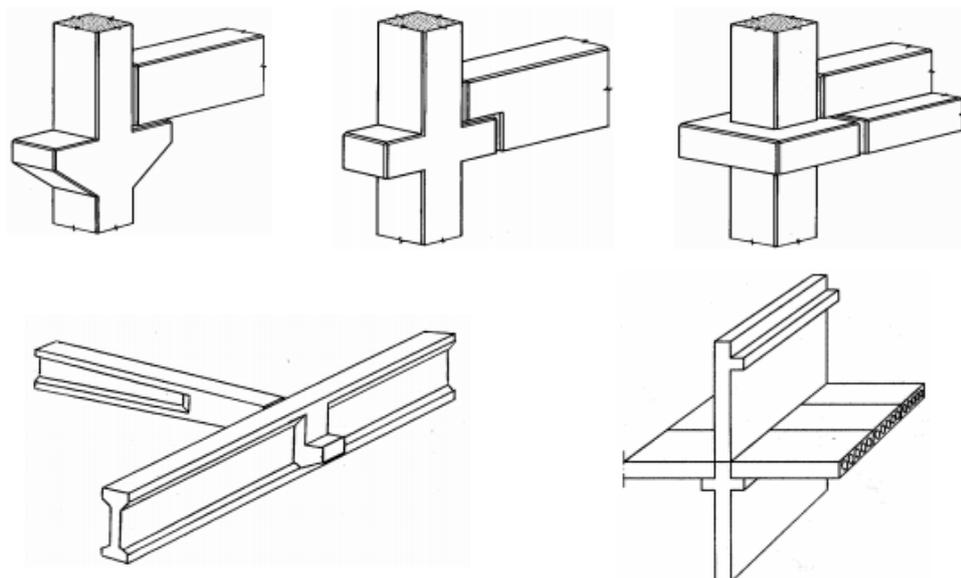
Consolos para apoio em estruturas pré-moldadas
